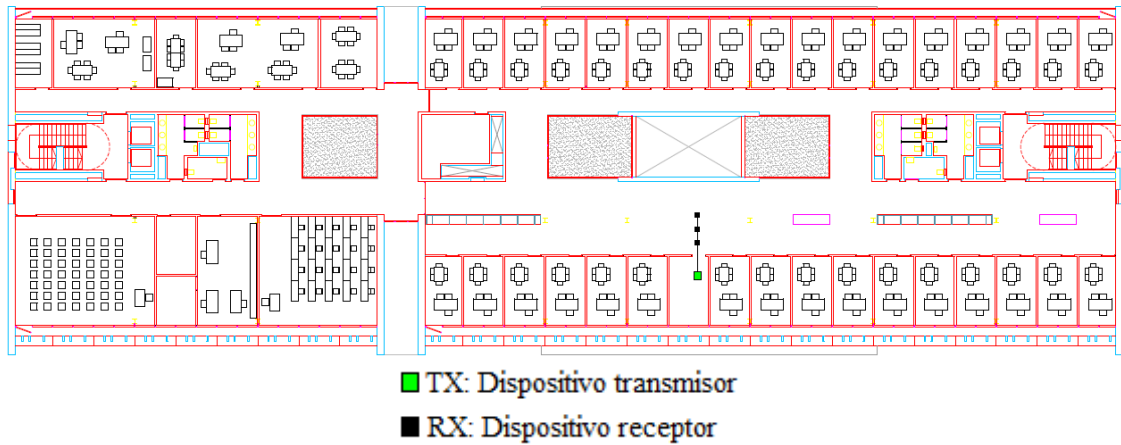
Plano general de la posición de los dispositivos en las medidas con la puerta abierta y el muro del despacho de por medio.
